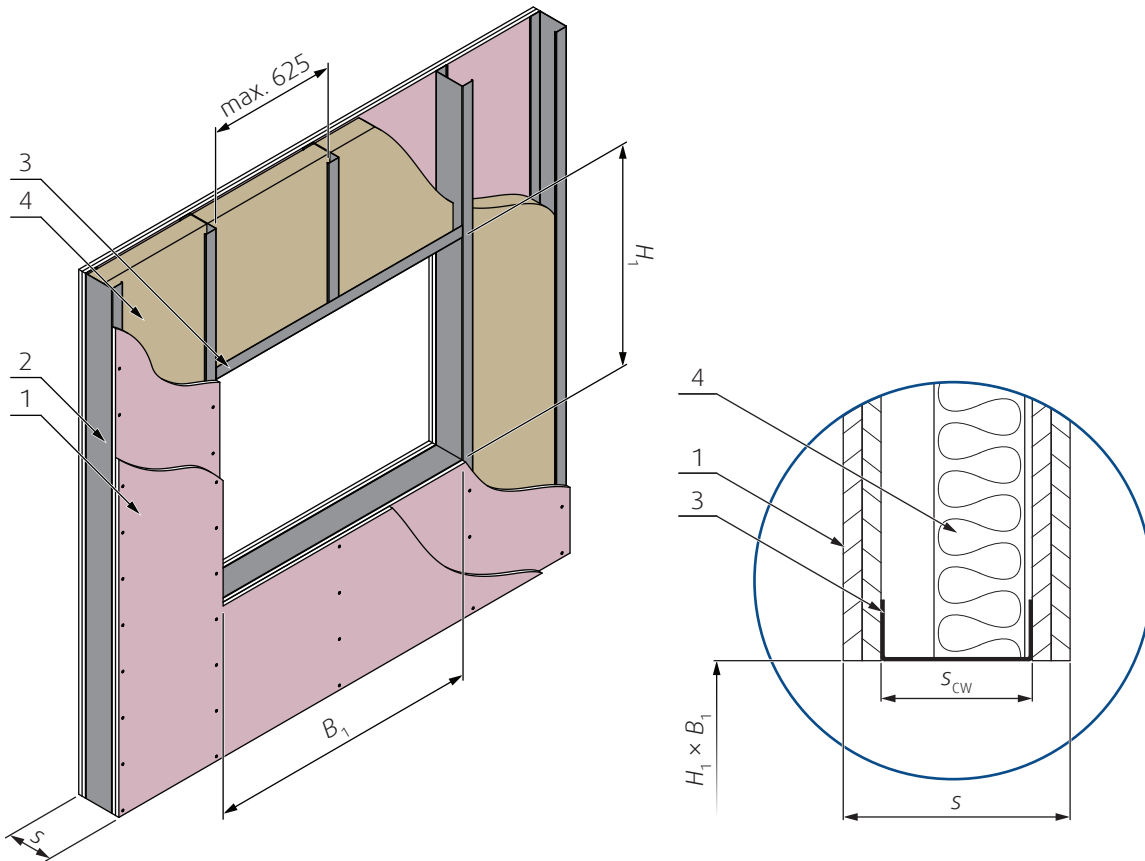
Leichtbau Wand mit rechteckiger Öffnung und vertikalem Querschnitt (rechts)
